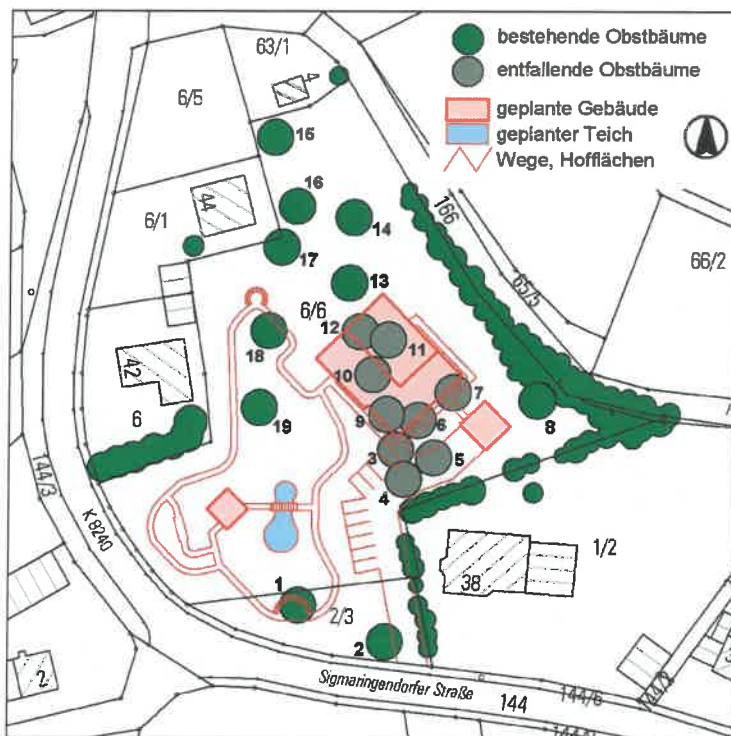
Lageplan der Obstgehölze (M. 1:1.500)
